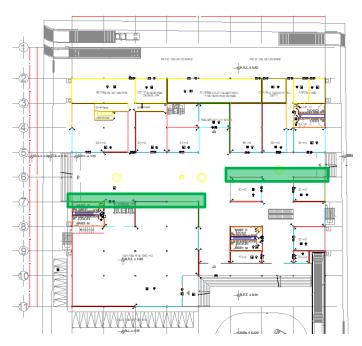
Ubicación en el plano de muro verde. Fuente: Elaboración propia.
